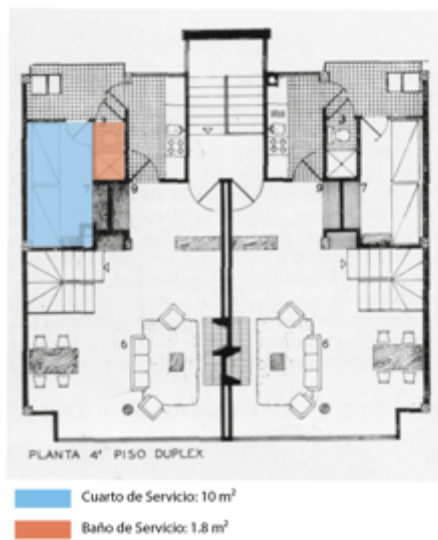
Planta del 4º Piso – (primer nivel de dúplex) – Ortega y Solano – 1950
